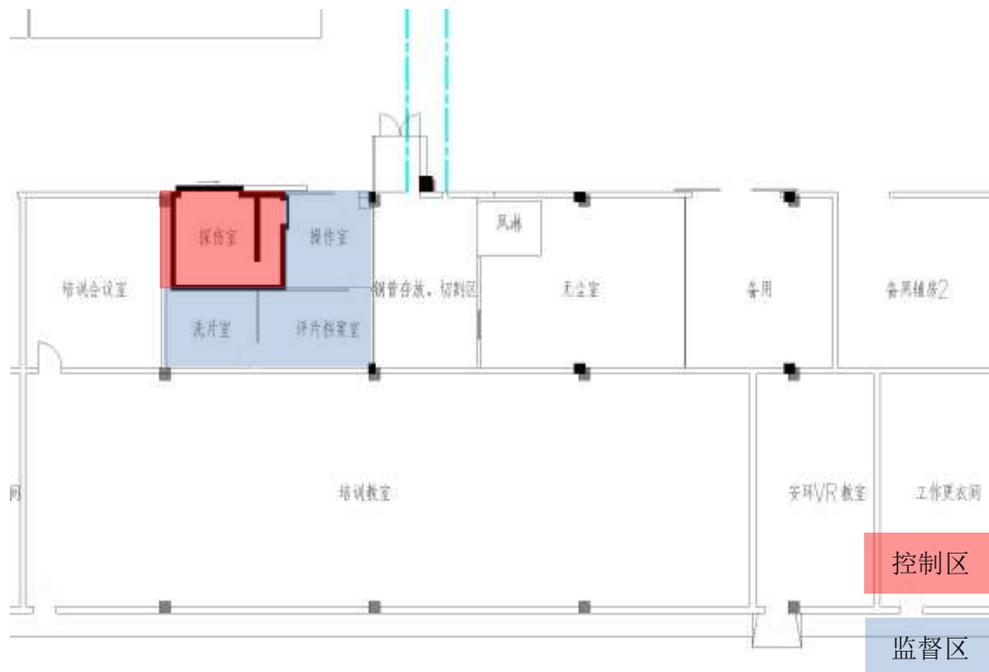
固定式X射线探伤铅房平面布置及分区示意图
